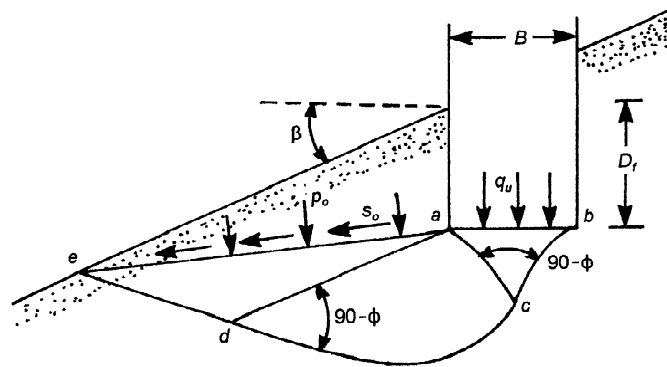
Nature de la zone plastique sous une fondation filante Rugueuse située sur une pente.
